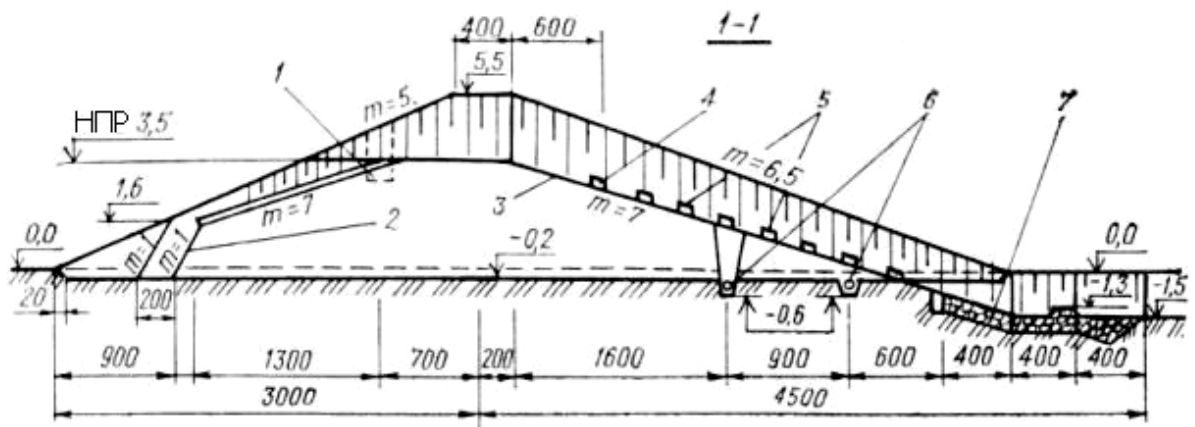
Грунтова водозливна гребля з асфальтобетонним покриттям
